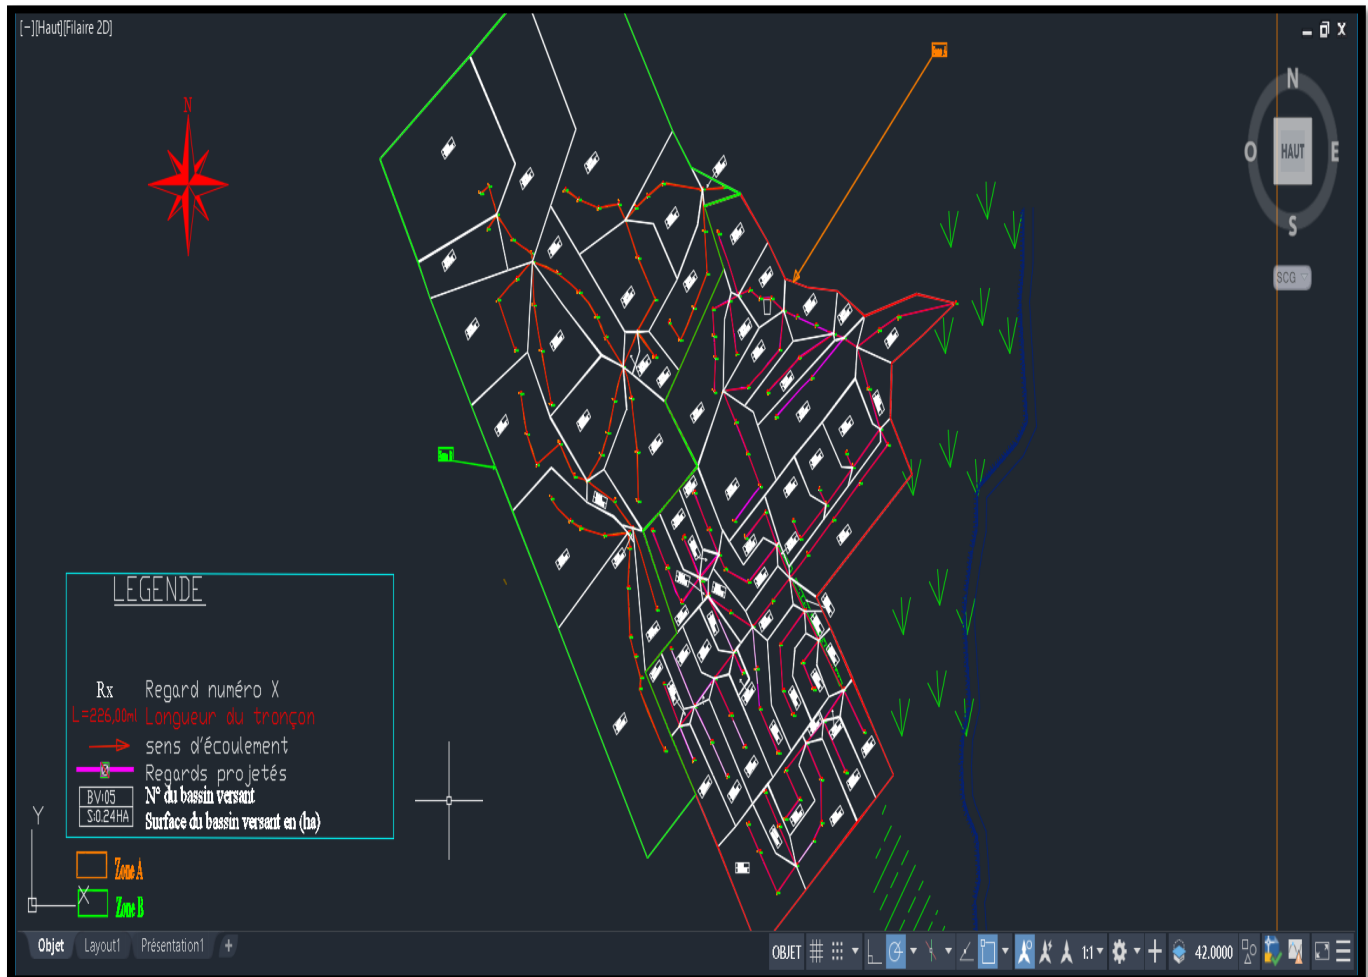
Plan de découpage en sous bassin versant de la zone d'étude (partie sud AIN EL HOUTZ)
